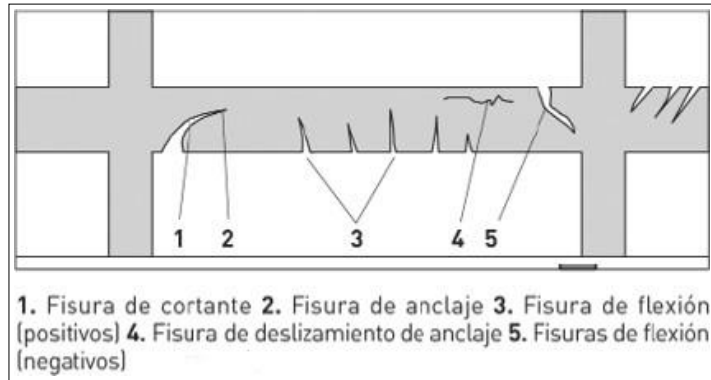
Fisura. – Fuente: Broto C.⁴²
